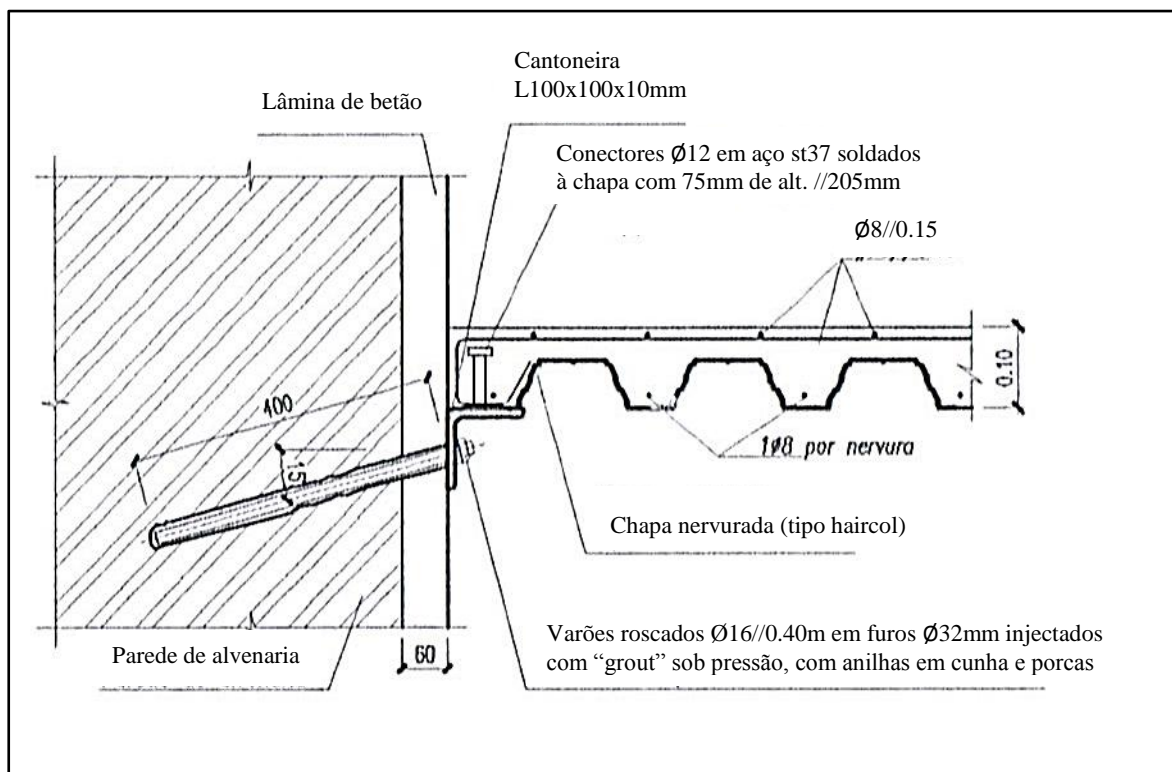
Ligação das lajes mistas aço-betão às paredes de alvenaria (com recurso a cantoneiras metálicas L100x100x10mm) (Fonte: projecto do Edifício da Rua do Alecrim da empresa a2p).
